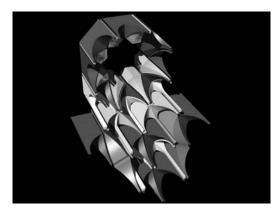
Reconstrucción volumétrica que muestra el montaje de la bóveda de mocárabes de la mezquita Ben Joussef en Marraquech, el dibujo muestra en detalle el arranque de la bóveda (dibujo del autor)
